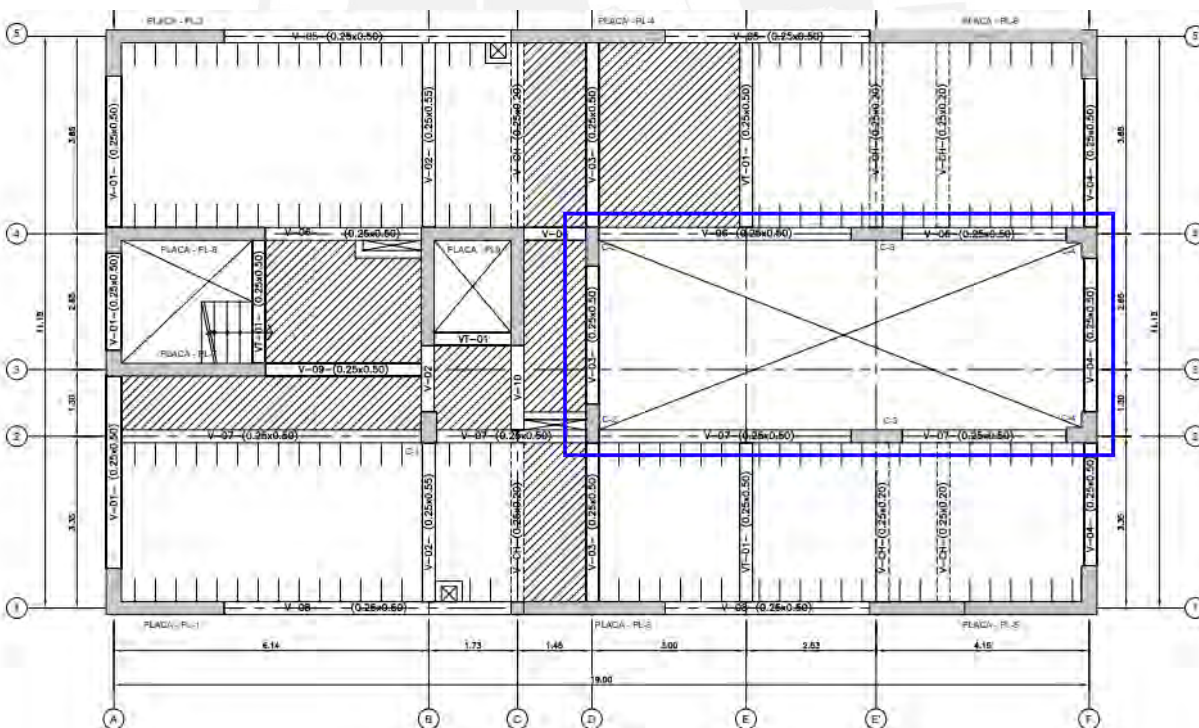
Detalle de irregularidad en esquina entrante- planta típica.
